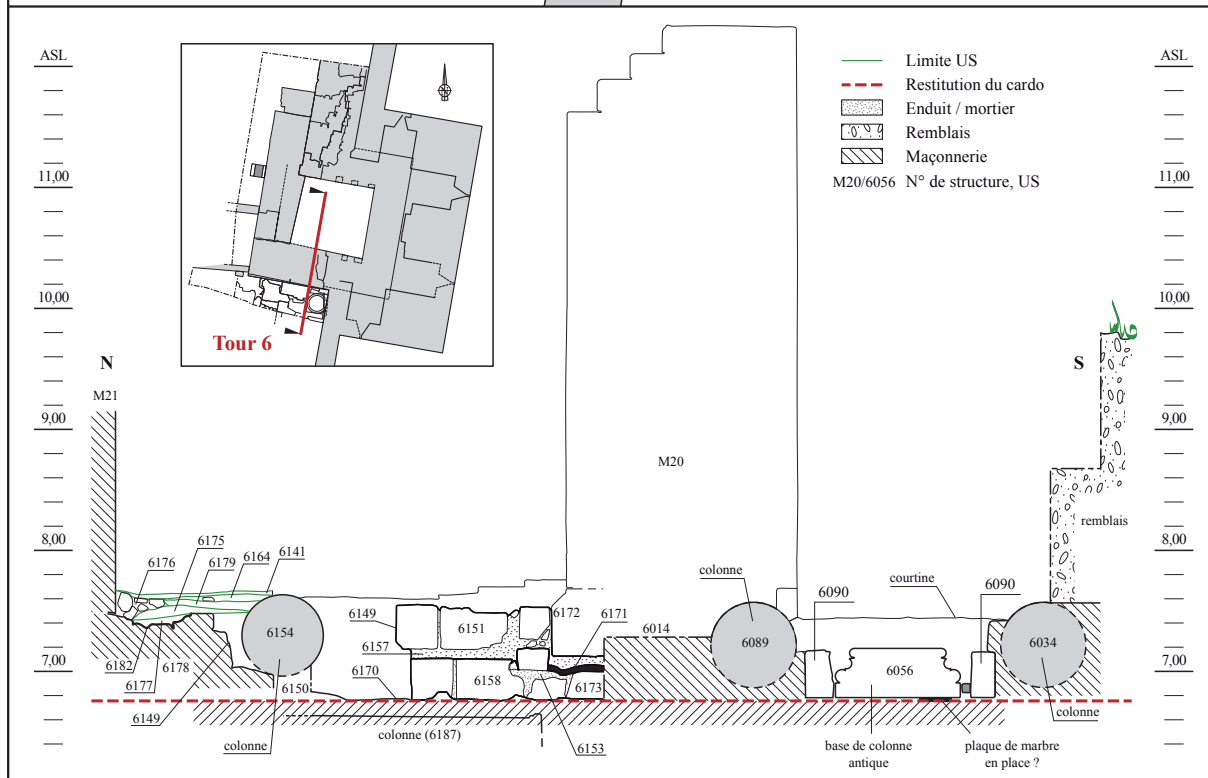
Plan et coupe des fondations arabes anciennes (Fabien Sanz-Pascual, 2010)
